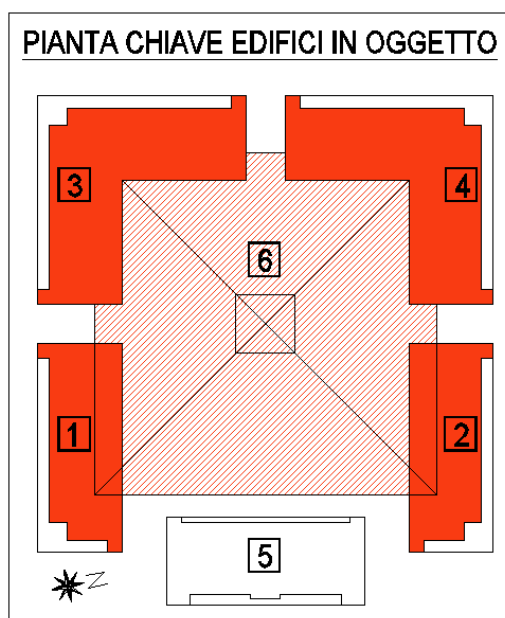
1: PIANTA CHIAVE DEGLI EDIFICI IN OGGETTO.
